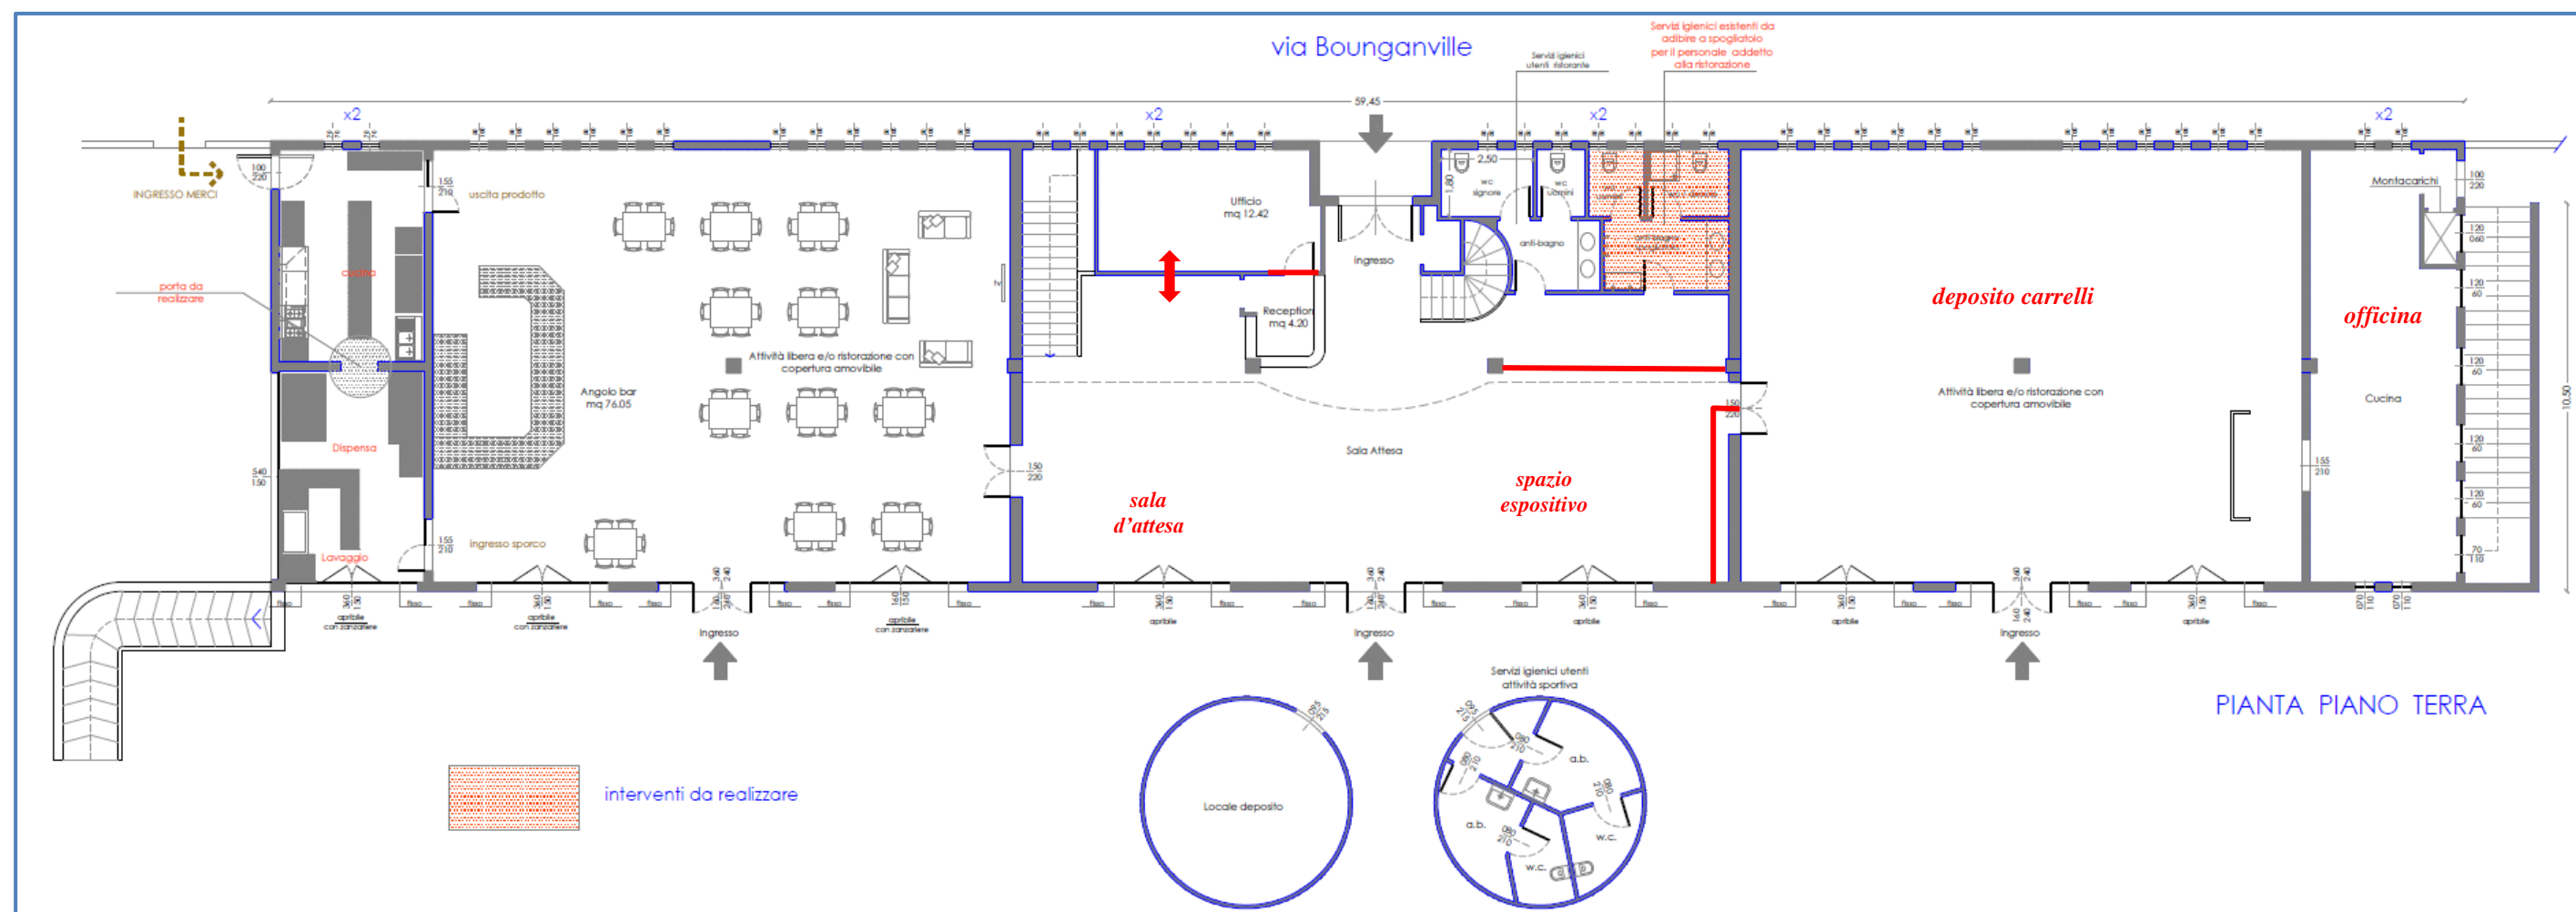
estratto della "Tav. n°2" del progetto allegato alla "pratica SUAP n°2474/2014"
